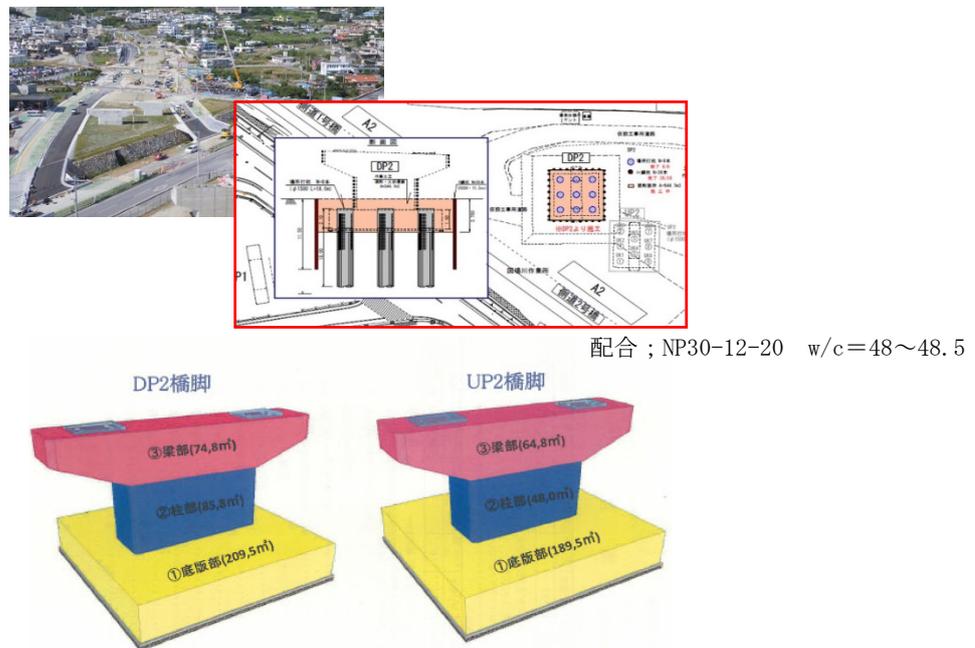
北丘高架橋の施工位置およびコンクリート打設箇所
